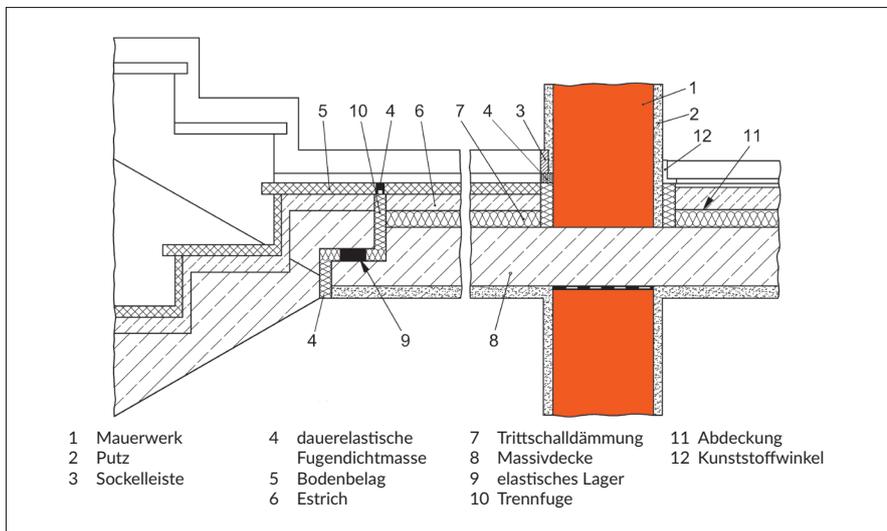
Schwimmender Estrich auf Podesten mit dämmender Zwischenlage bei Auflagerung der Läufe (Schnitt B-B).
